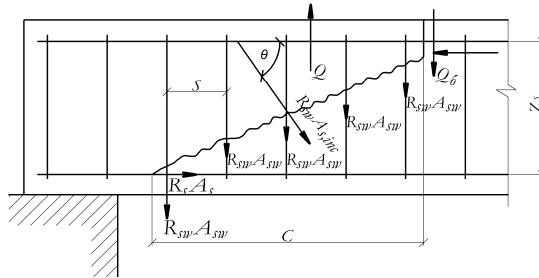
Схема зусиль в перерізі, похилому до повздовжньої осі залізобетонного елемента при розрахунку його по міцності на дію поперечної сили.
